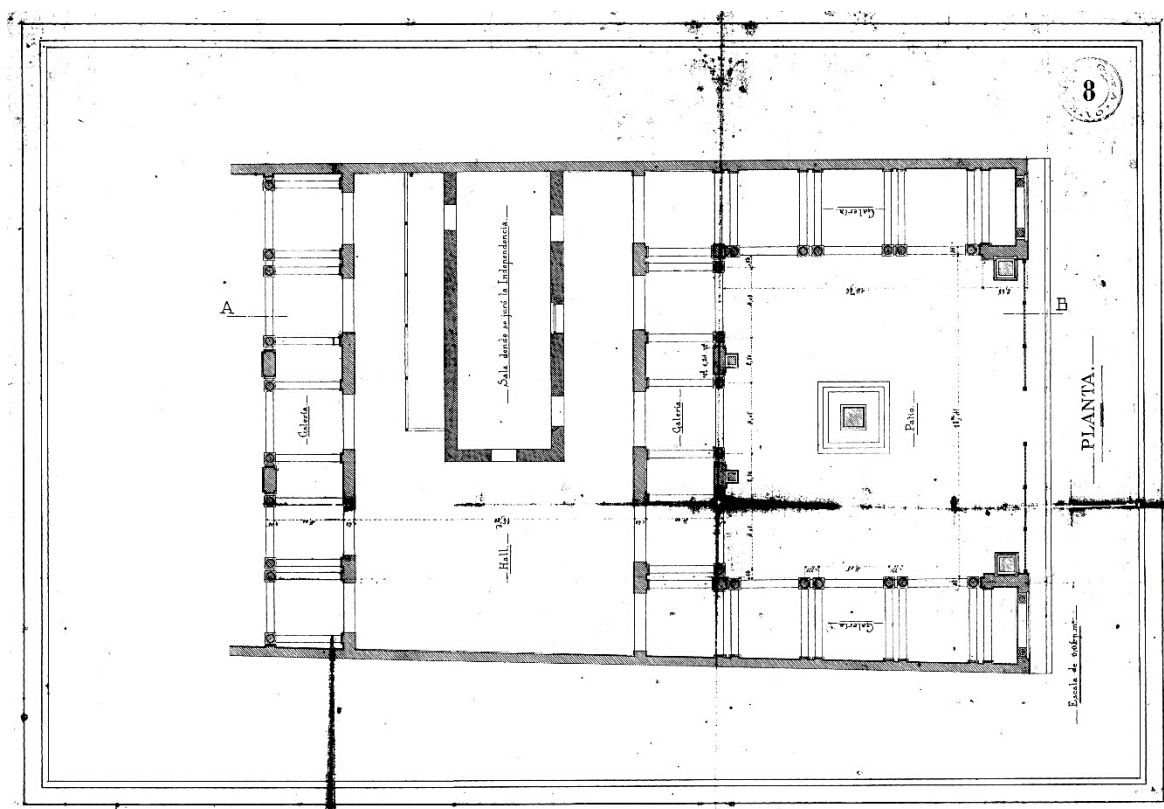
Planta del proyecto original. Plano N° 8 DNOA
